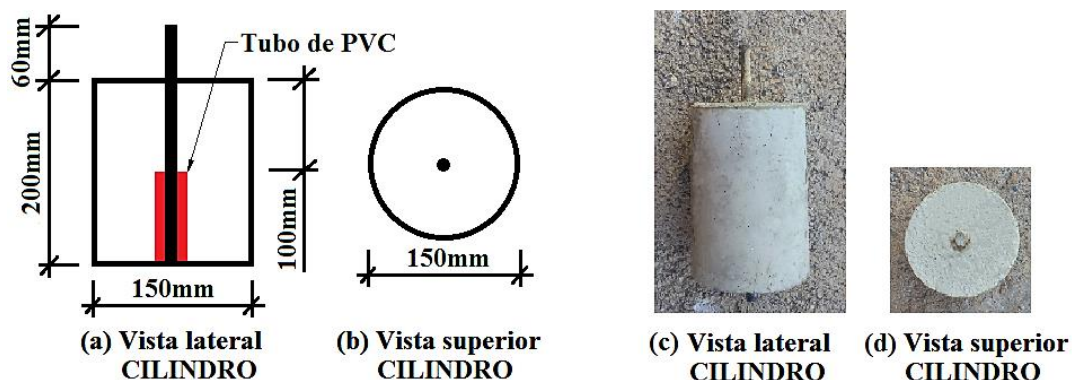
Dimensões e forma final dos corpos de prova da Etapa I.
